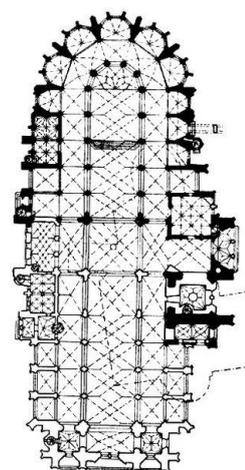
Prag, Veitsdom, Grundriss, ab 1344
